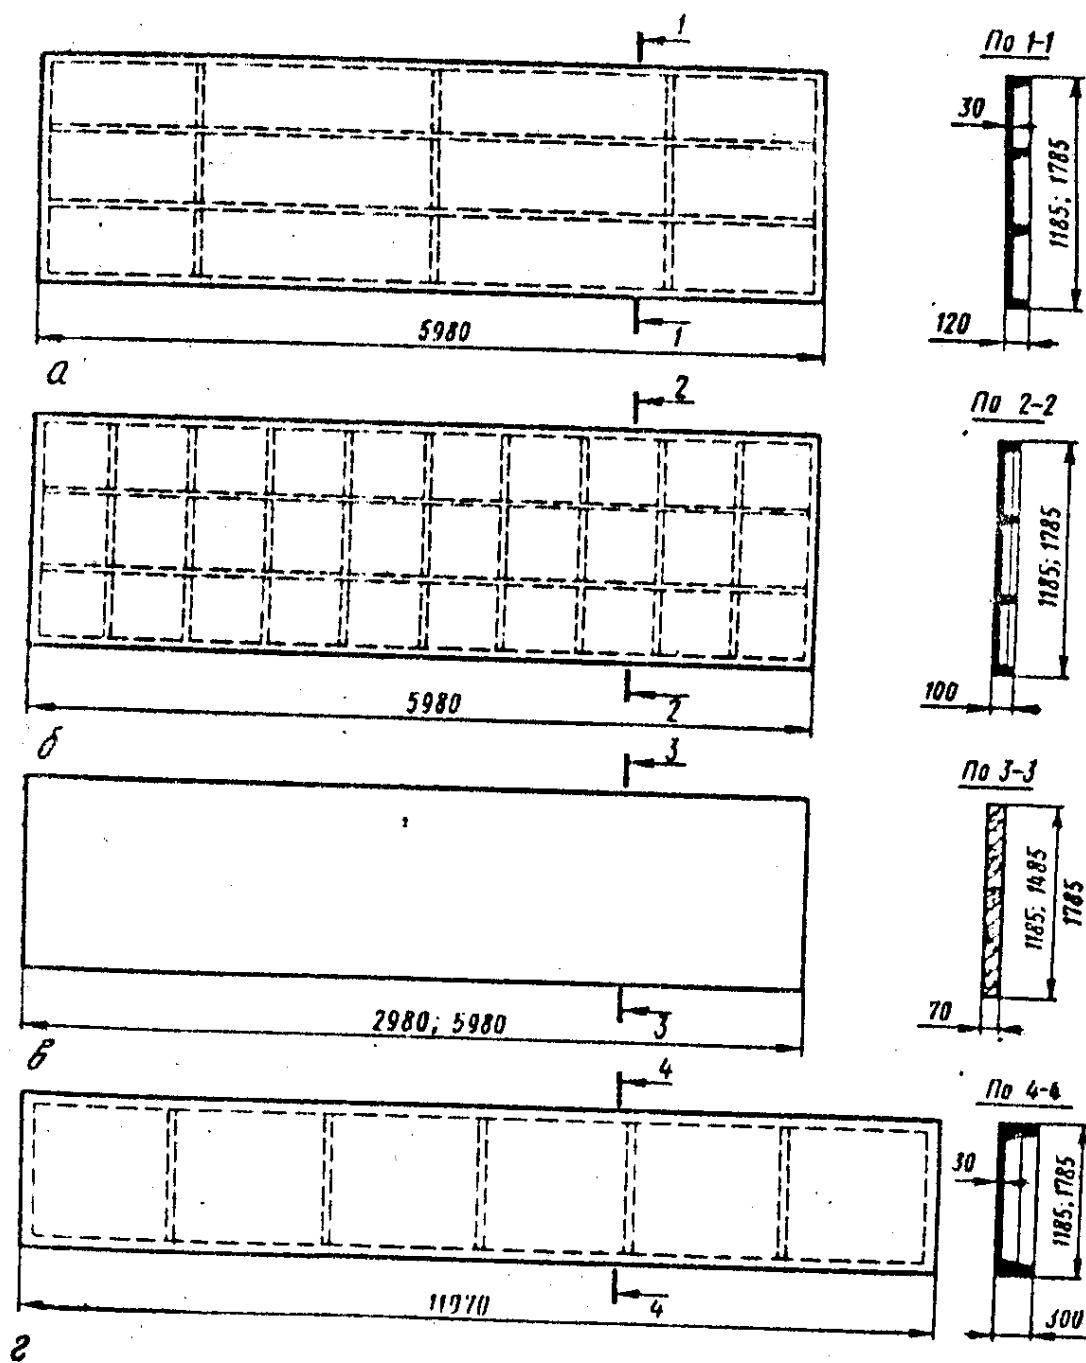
Схеми залізобетонних панелей для стін неопалювальних будівель:
